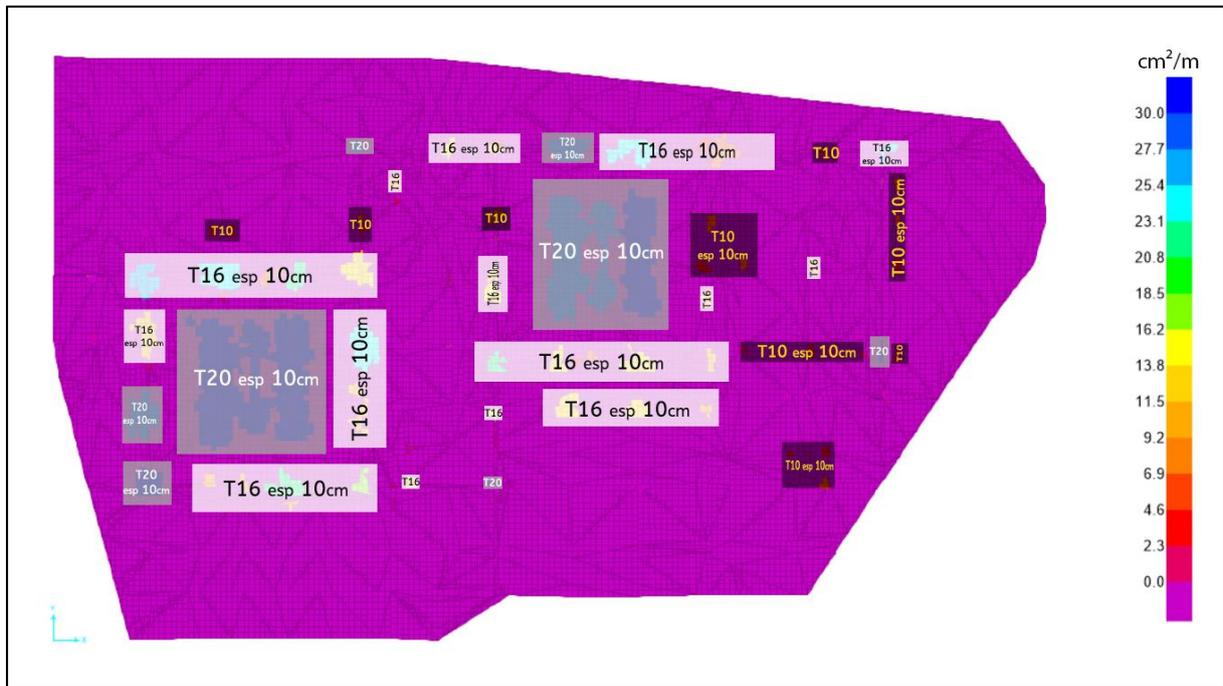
Renforts du ferrailage inférieur suivant la direction 1 (x).
